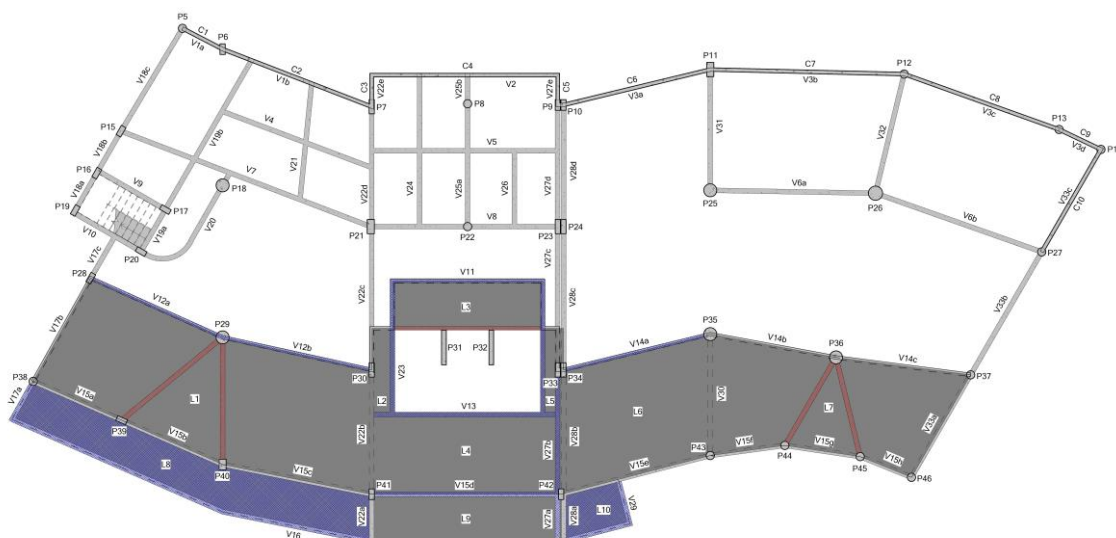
Planta Baixa Nível 1 (segundo subsolo)
